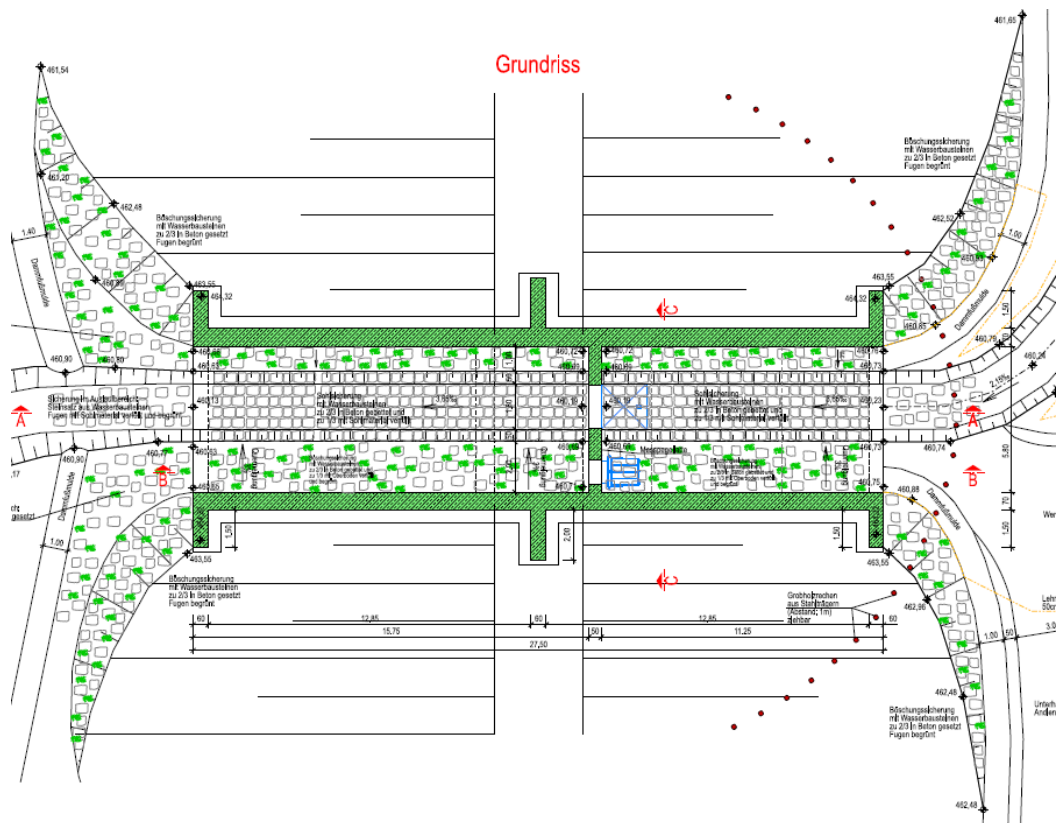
Durchlassbauwerk Grundriss o. Maßstab. Quelle: Steinbacher-Consult
